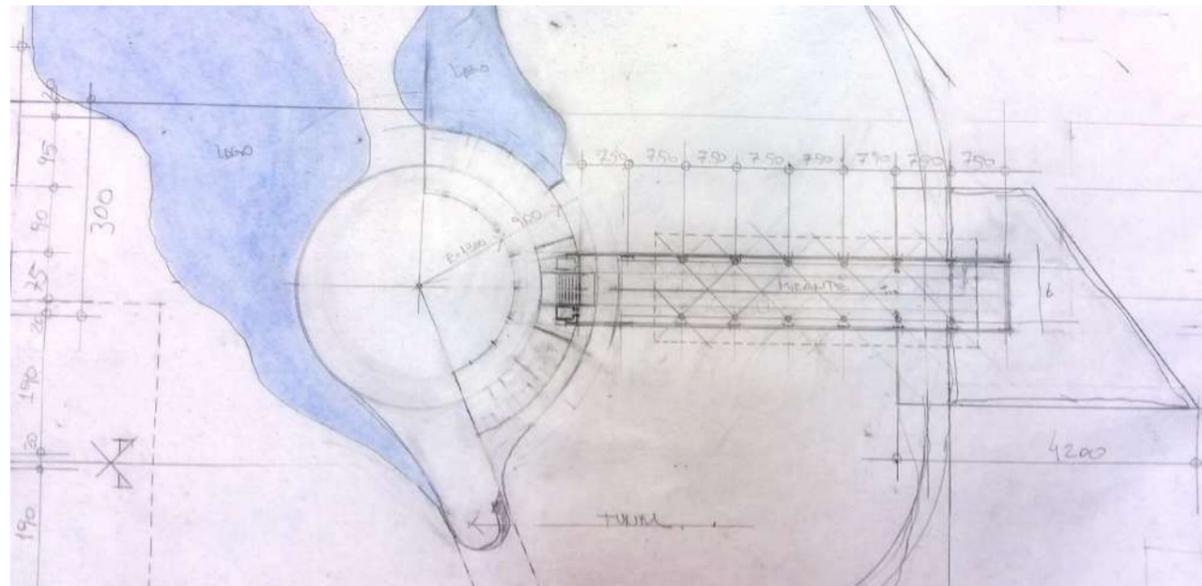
Croqui da Planta do Mirante - Desenho Magnabosco, M. 2014-
